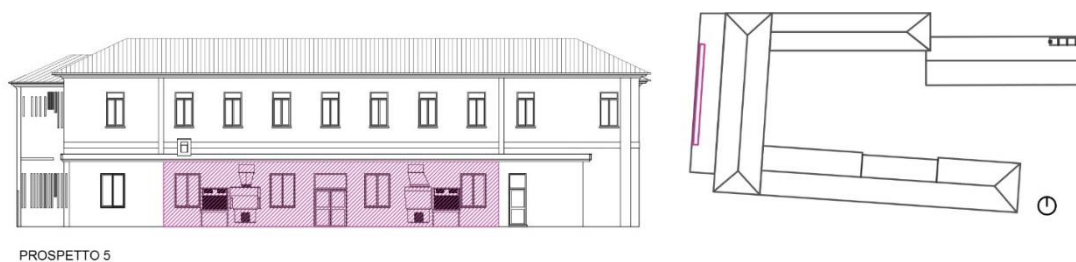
Individuazione del macroelemento in prospetto e pianta
